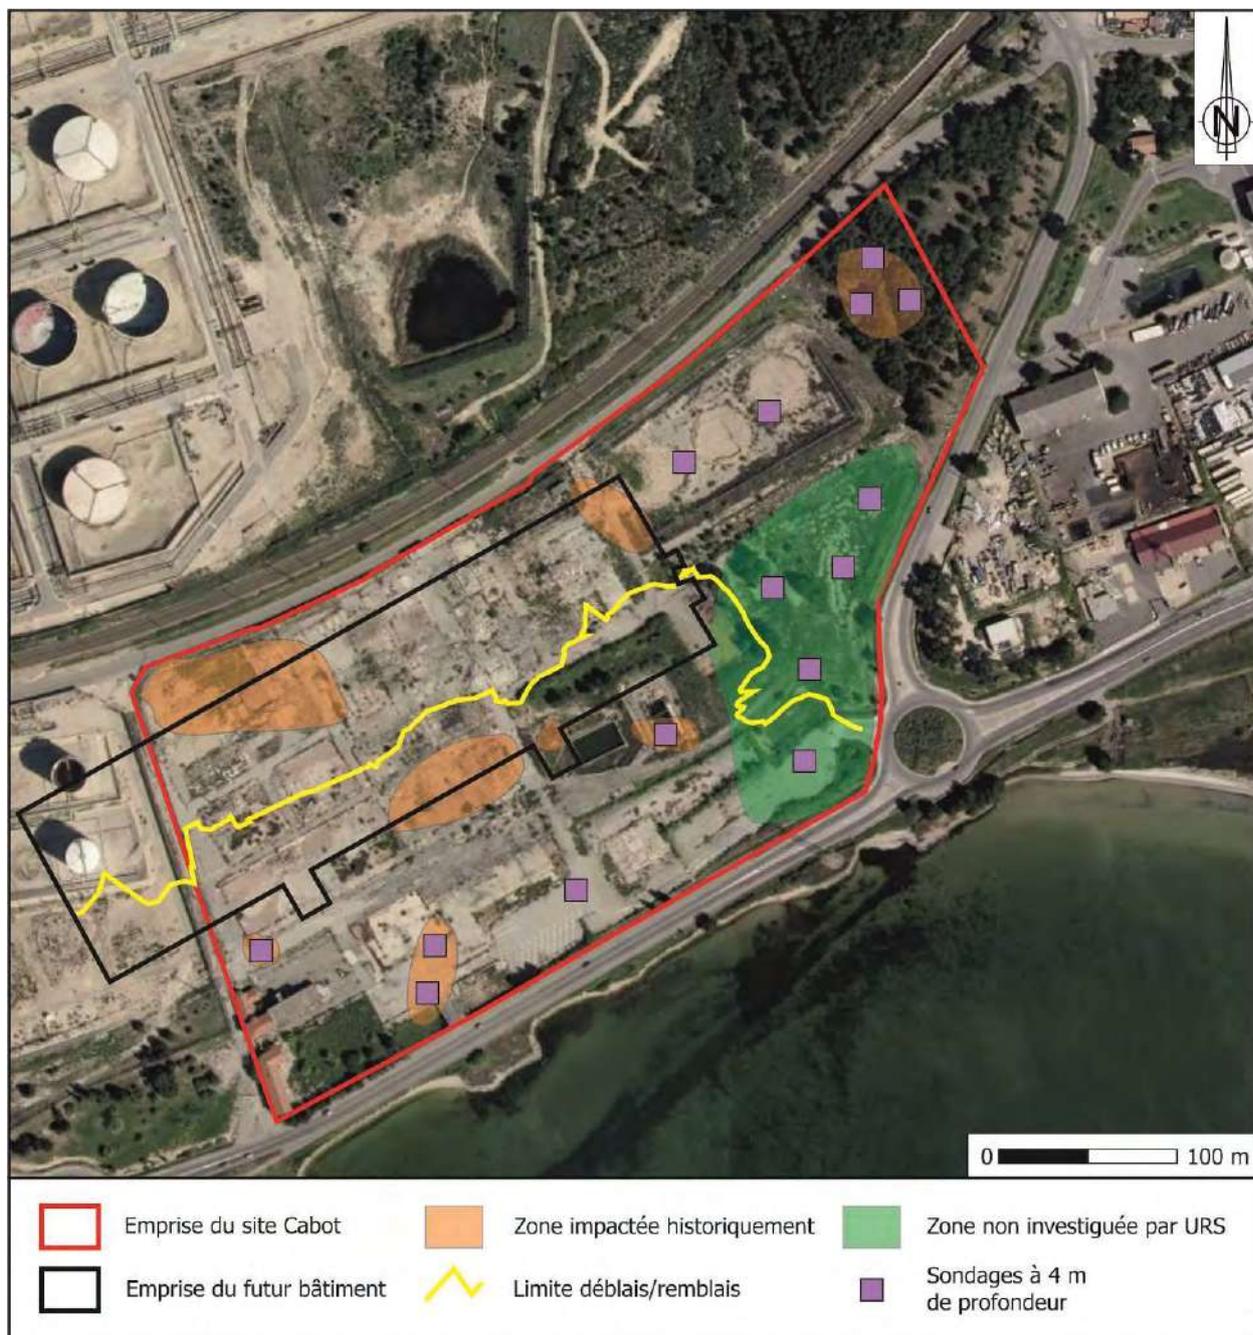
Plan d'implantation des sondages au droit des futurs espaces extérieurs
